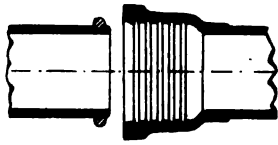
Einbringen der Rohre mit Gummidichtung.
